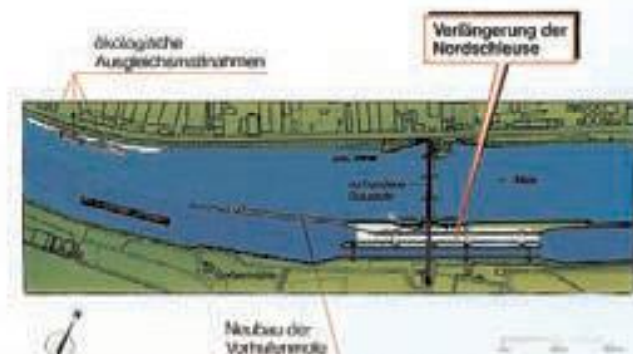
Ausbau der Schleusenanlage Offenbach: Lageplan
